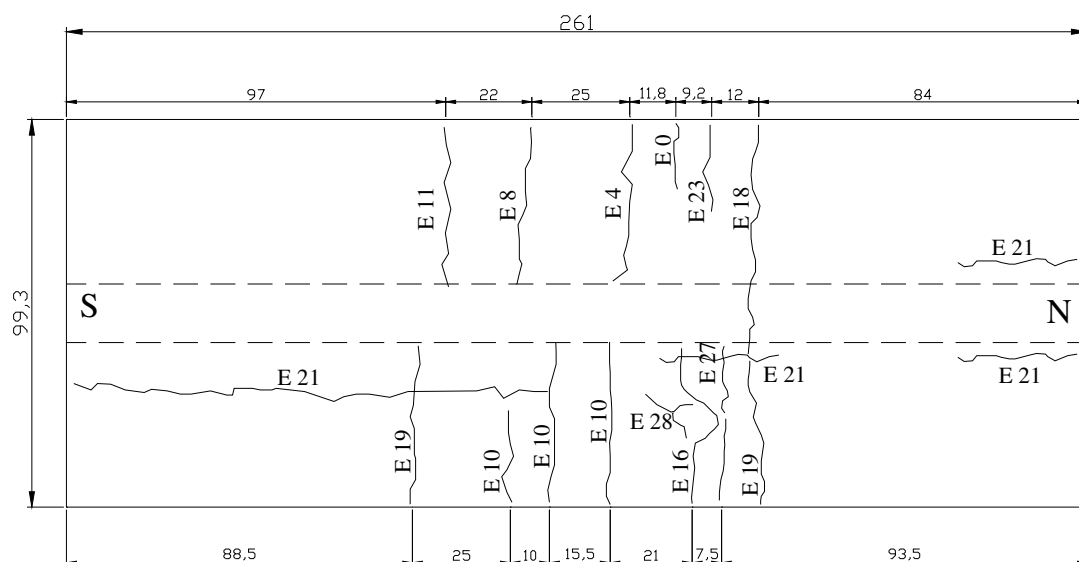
Fissuras do modelo 1BE (Face superior da laje) – medidas em cm.
